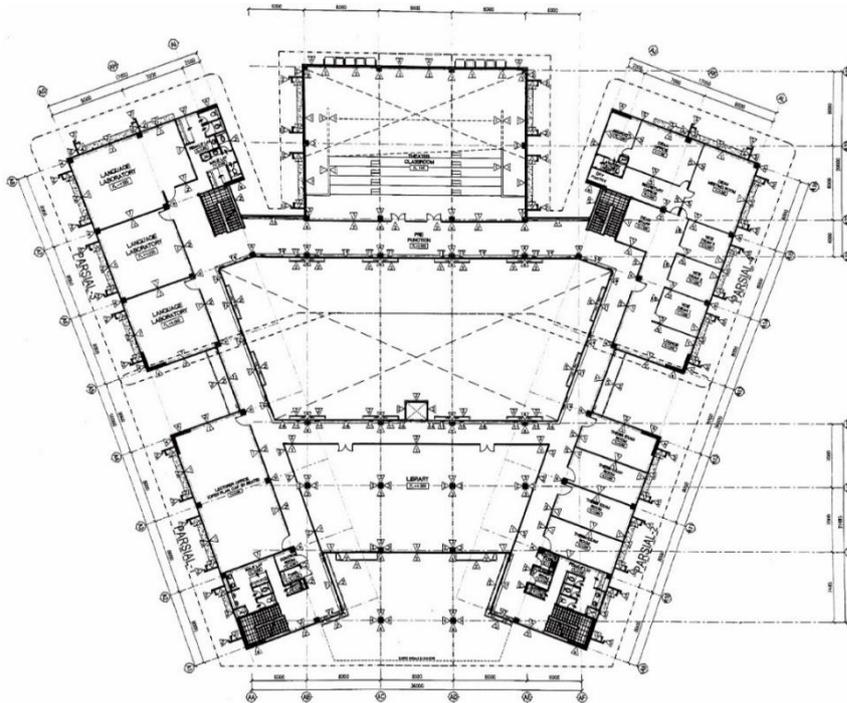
Parsial-2 denah rencana *finishing* dinding lantai 1
